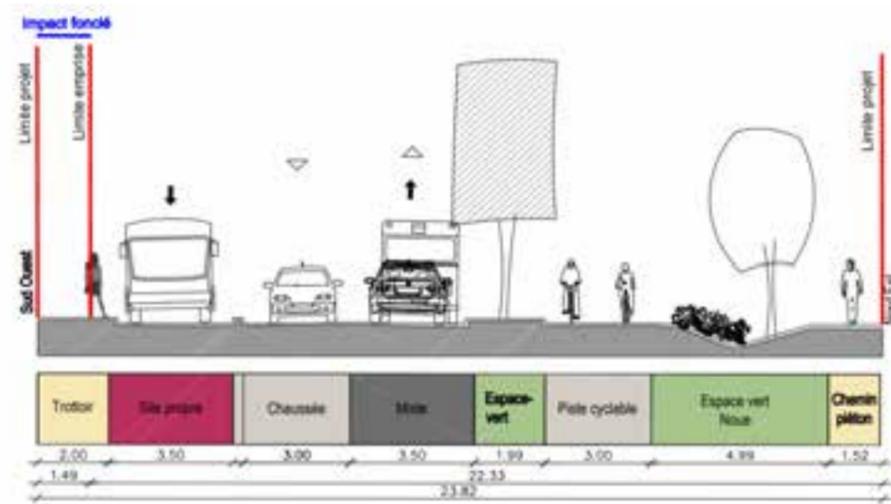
Coupe type en section courante sur le boulevard du Parisis
